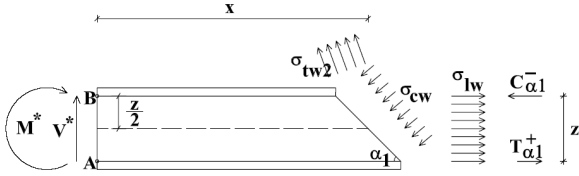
Tronco di trave, sezionato all'estremità con piano parallelo alla direzione delle staffe α_1
